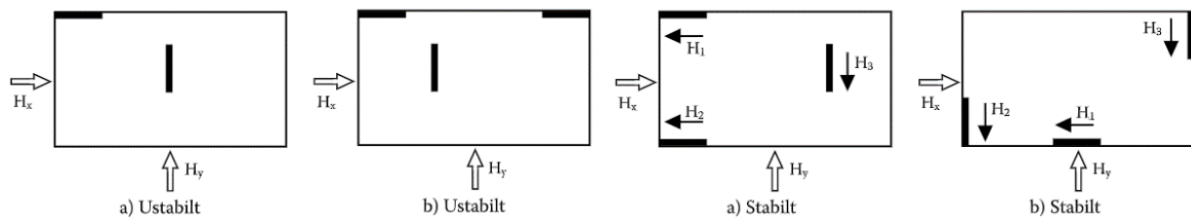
Oversikt over hvordan lastene blir fordelt i avstivningsystem. Hentet fra betongelementboken.
